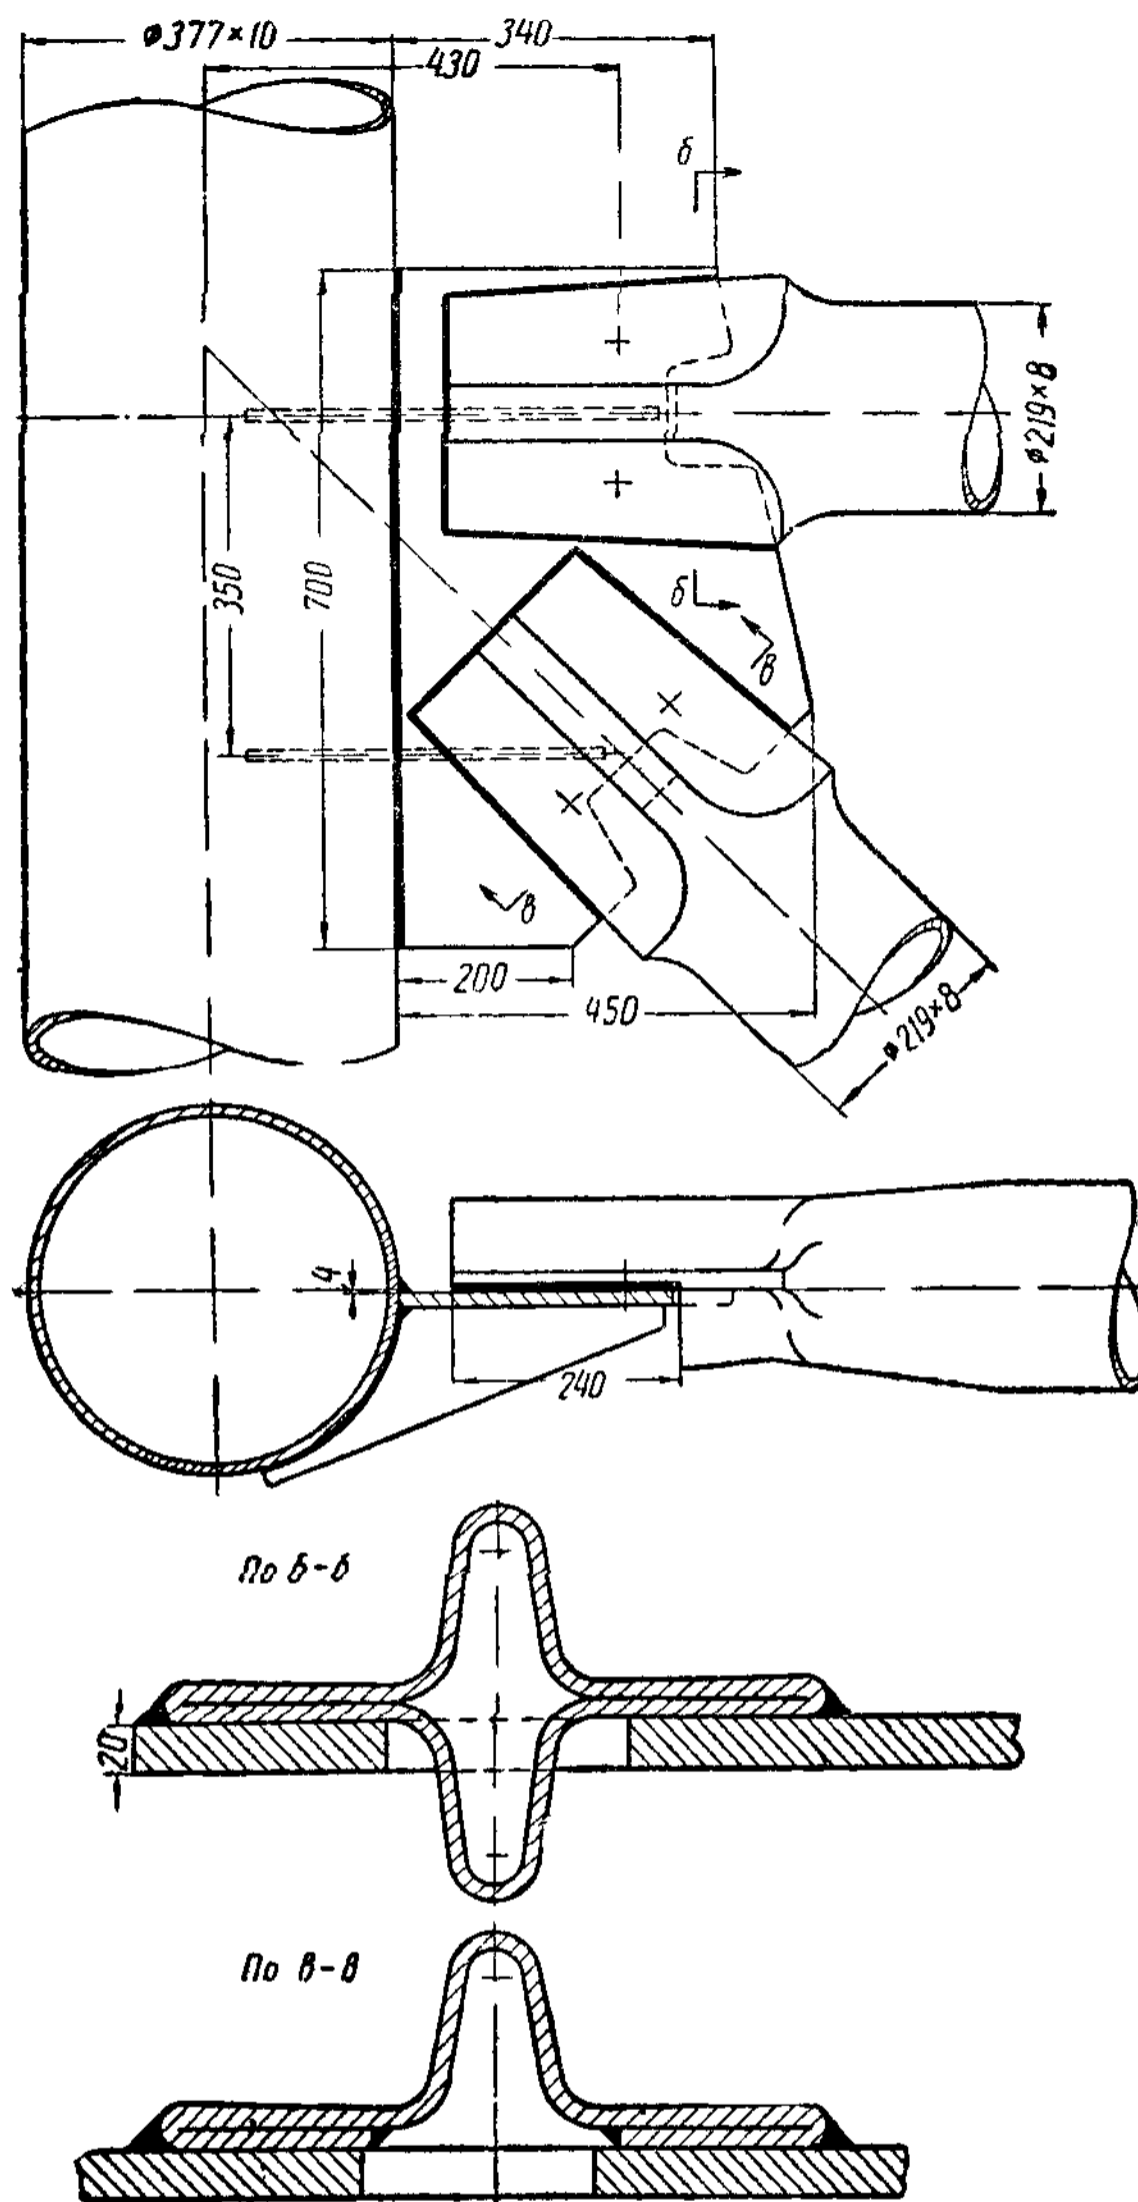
Монтажный узел тяжелой трубчатой фермы на сварке
